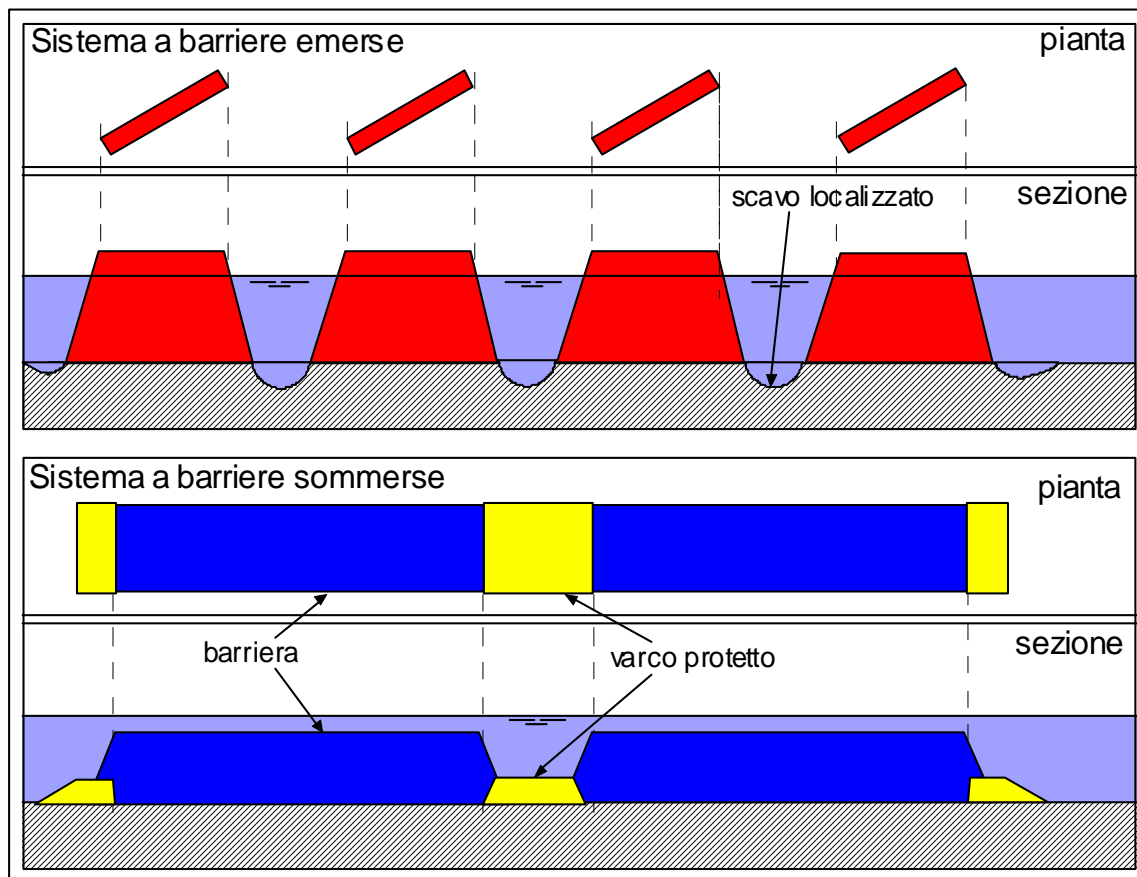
Pianta e sezioni dei sistemi a barriere emerse e sommerse.
